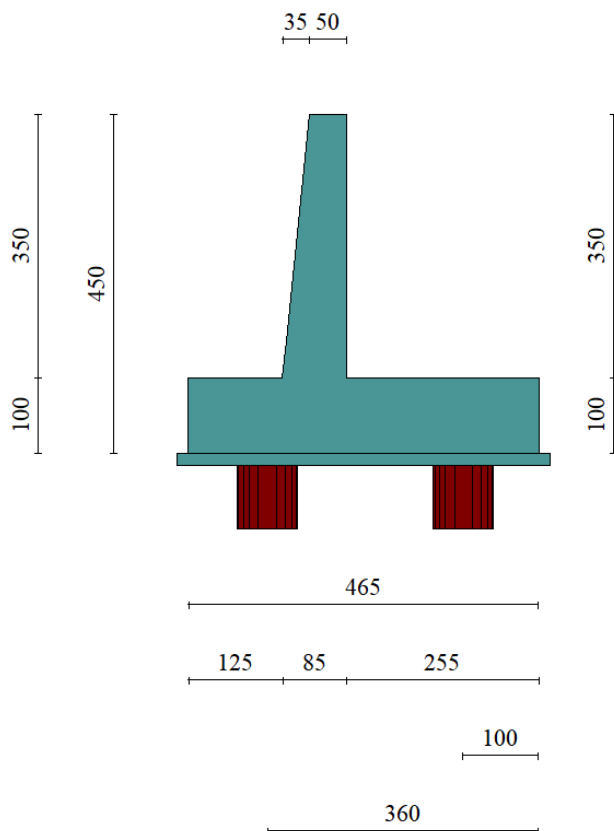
Geometria dei MURI DI CONTRORIPA - FONDAZIONE SU PALI - TIPO 1
